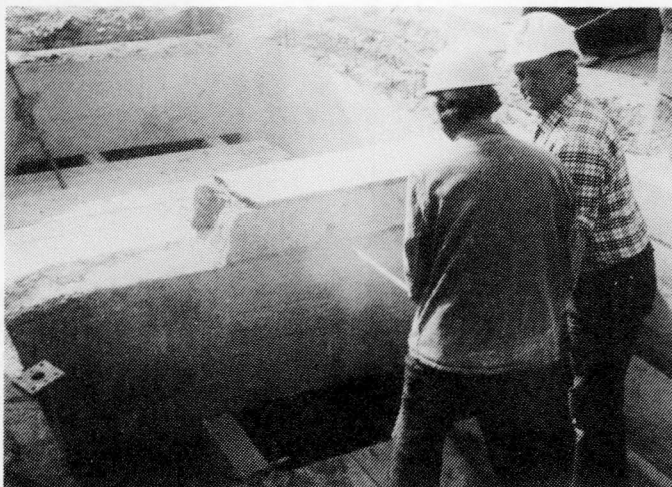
Abbruch der Restbetonflächen über den Rahmenriegeln, Randunterzügen und der Trogwand im Strombrückenbereich; Durchführung der Arbeiten vom Holzauslegergerüst über den Arkadengängen aus
